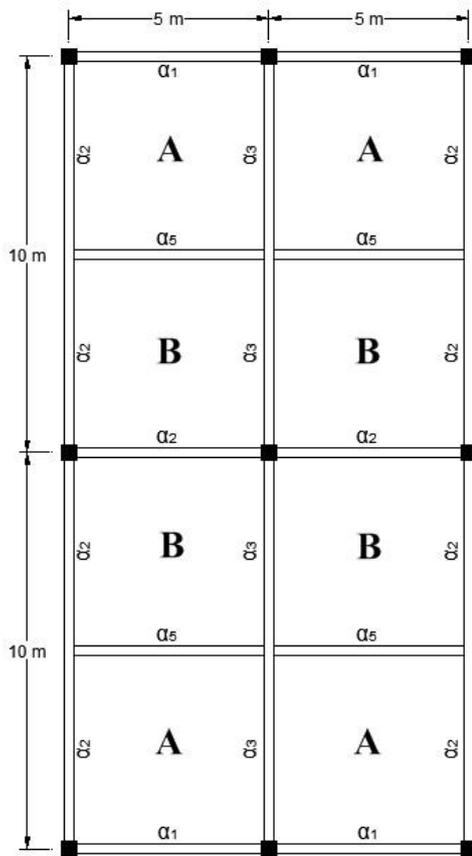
Denah Model Struktur Tipe B3 (dengan dua balok anak)
